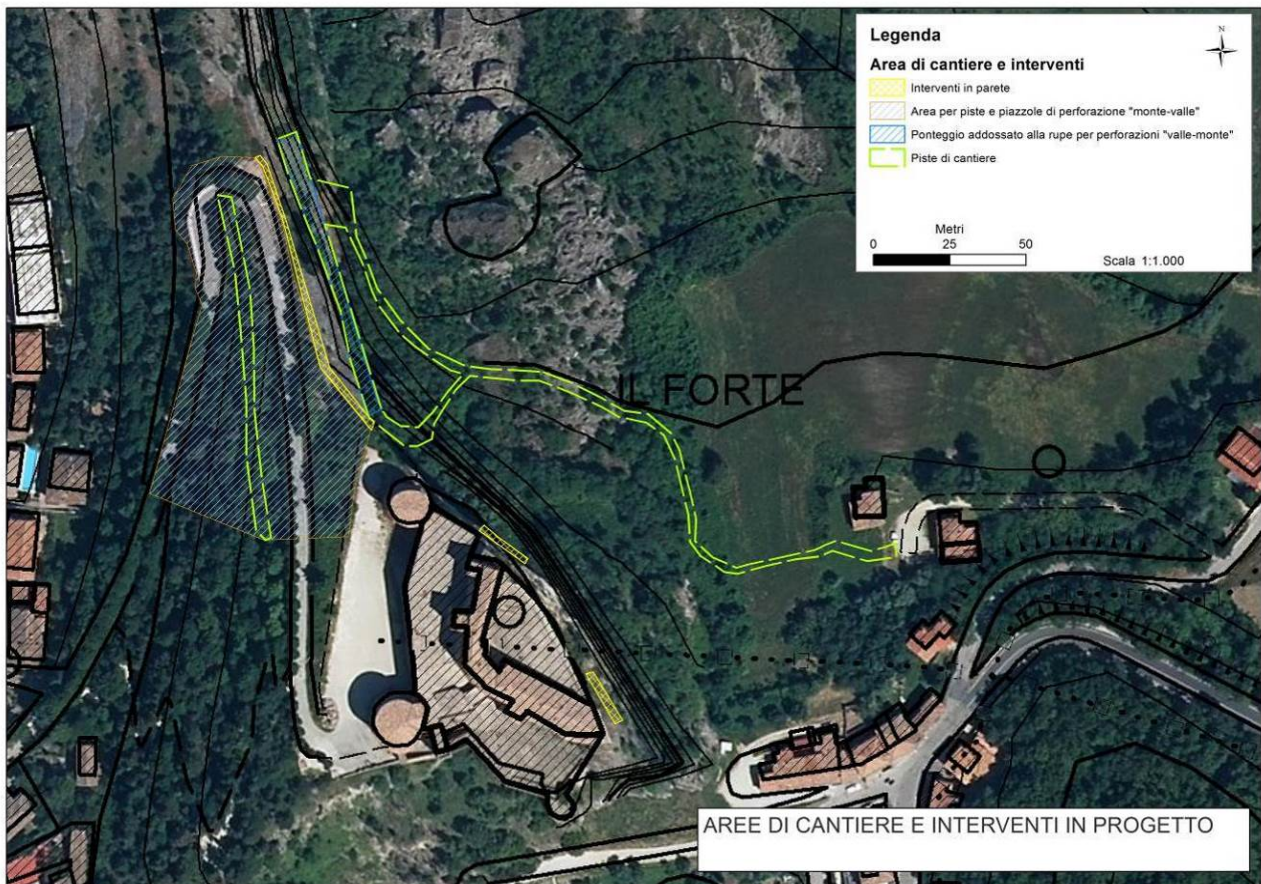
Planimetria con localizzazione delle aree di cantiere e degli interventi in progetto
